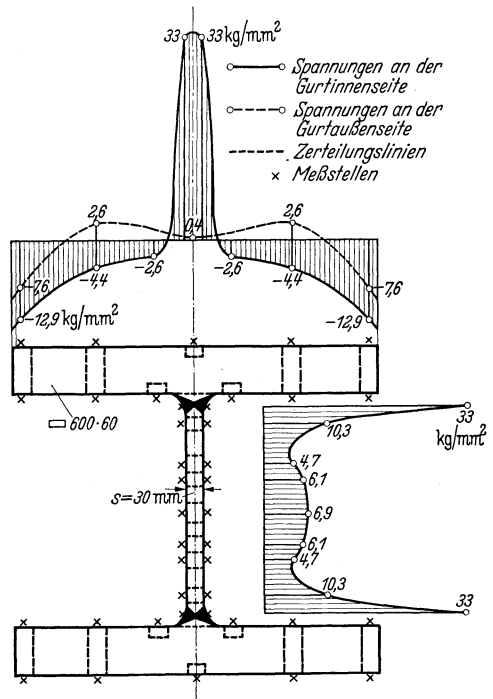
Eigenspannungen in einem geschweißten Ständer.
